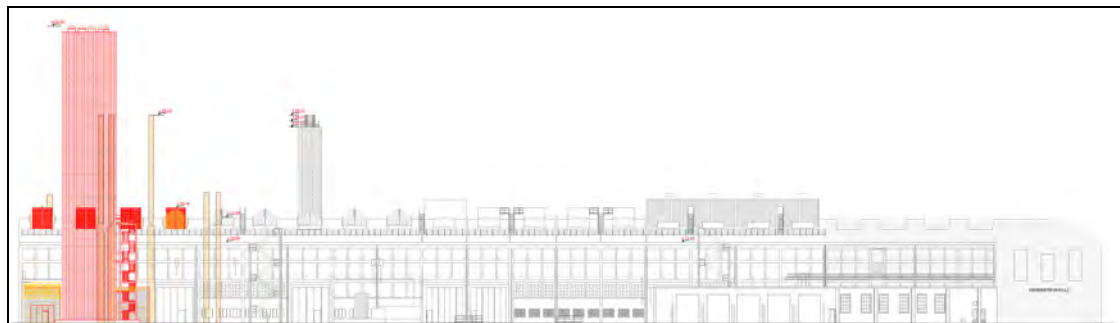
Estratto tav 03 – Progetto preliminare. Prospetto est (Confronto) (dall'interno della proprietà)
